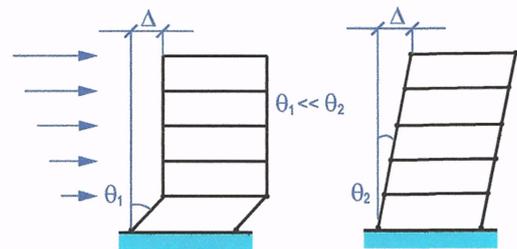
Повреждение здания из-за «гибкого» этажа
